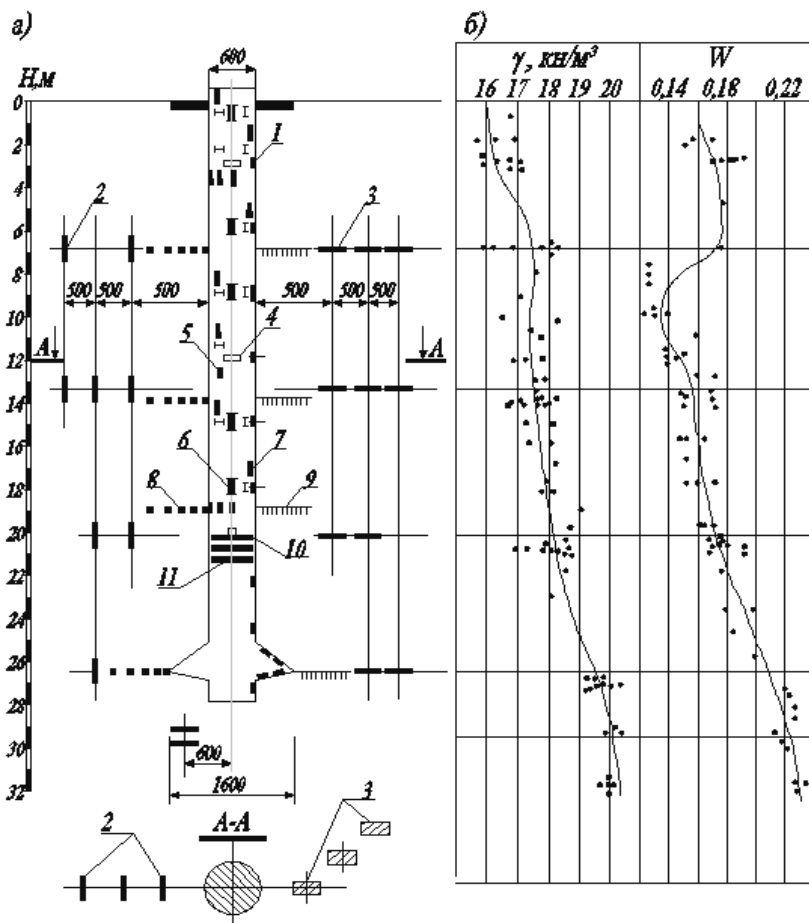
Схема расположения датчиков в свае и окружающем ее грунте (а) и распределение по глубине физических свойств грунтов опытной площадки (б):
